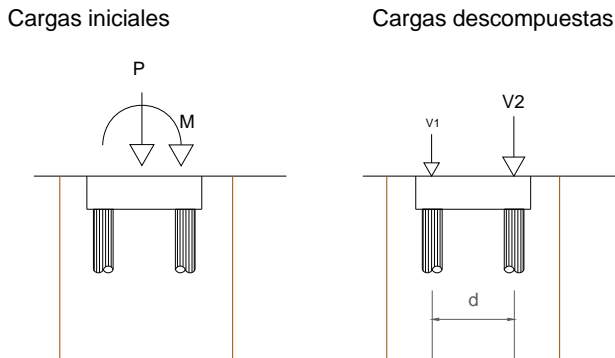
Cargas iniciales grupo de dos pilotes y cargas descompuestas para cálculo.
